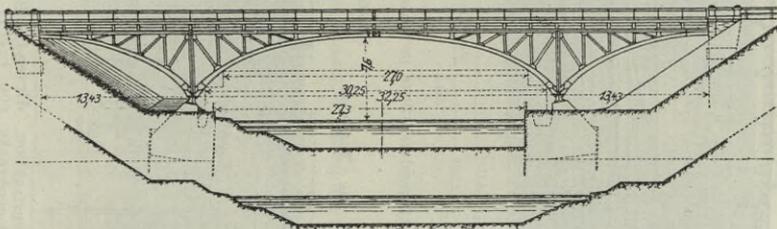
Brücke über den Elbe-Trave-Kanal bei Mölln. (Z. V. D. I. 1900, S. 769).
